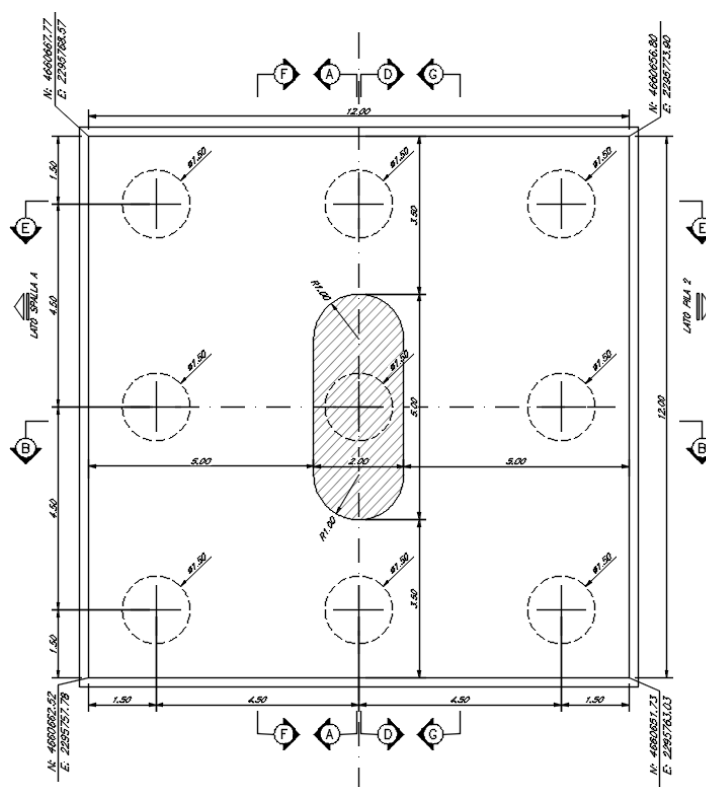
Vista in pianta zattera di fondazione con 9 pali di grande diametro
